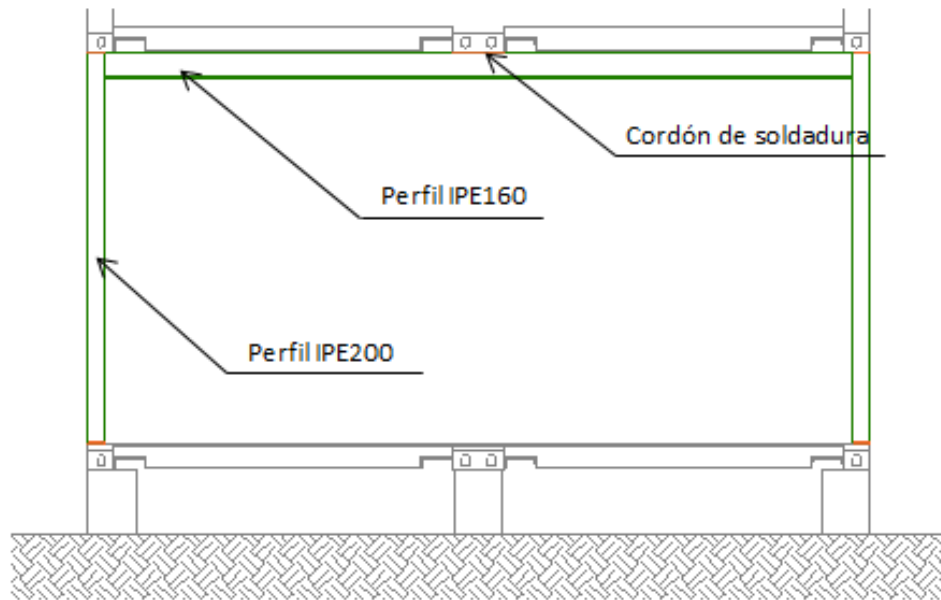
Detalle 1, refuerzo horizontal (IPE160).
